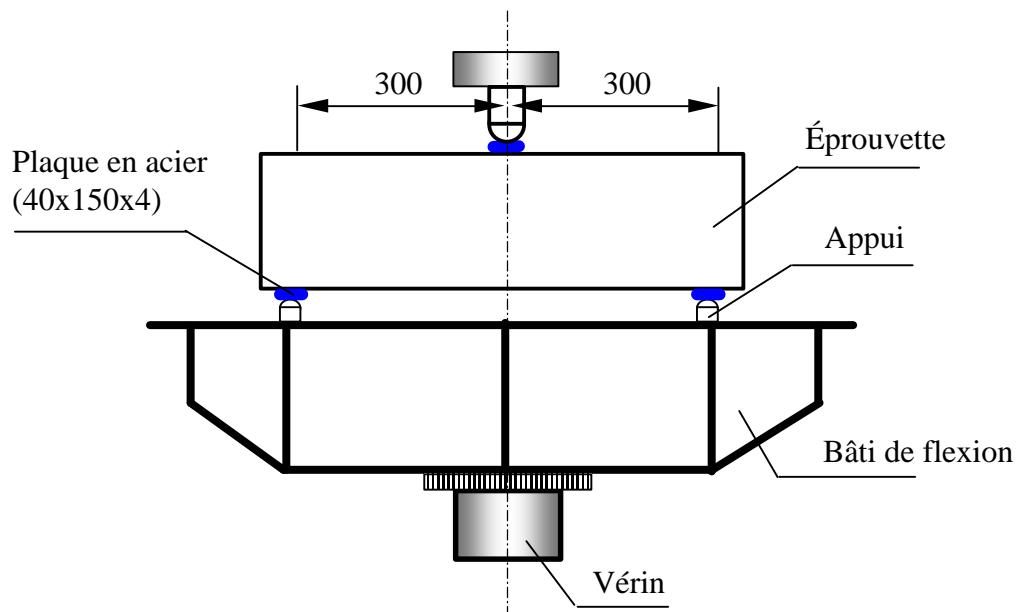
Dispositifs de la presse d'essai (unité: mm)
